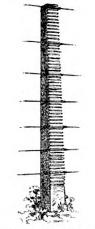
Betonpfahl mit Einkerbungen jum Einlegen von Zaundrähten.
